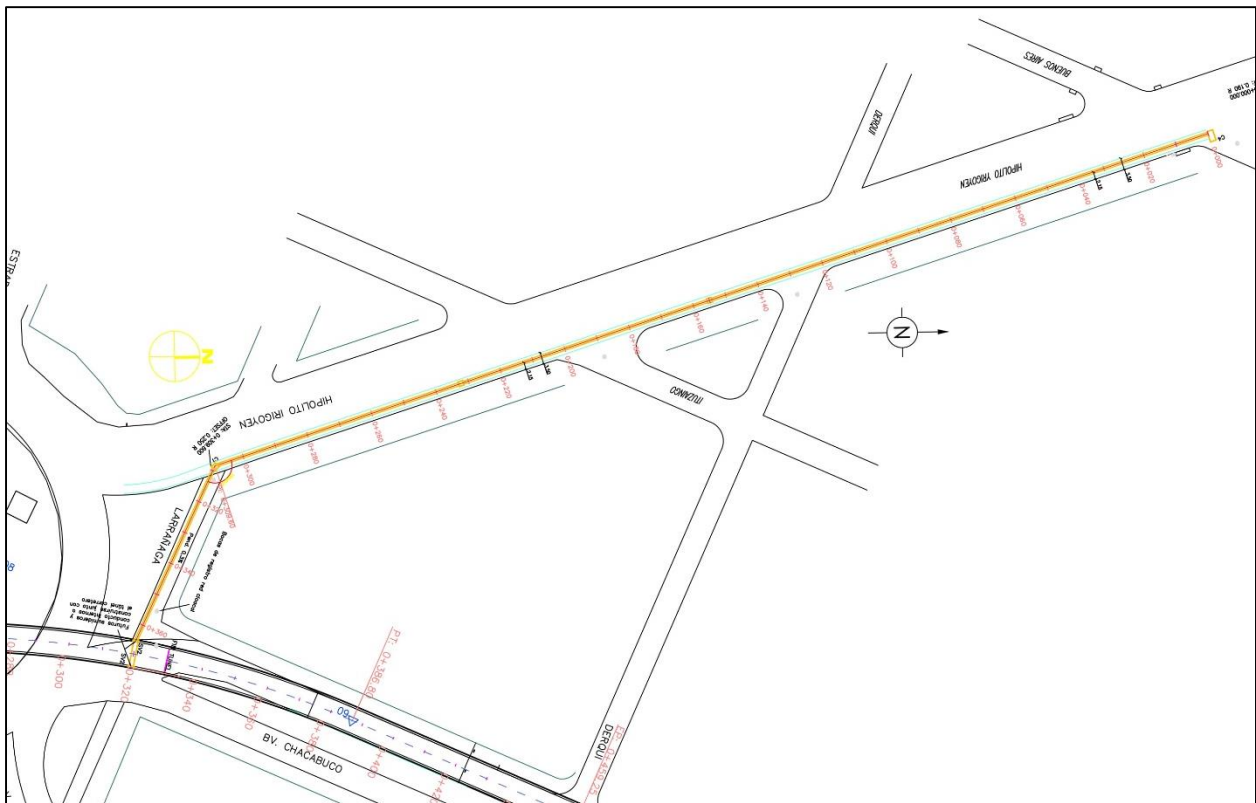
Planimetría obra de desagüe. (PLANO N°6)
